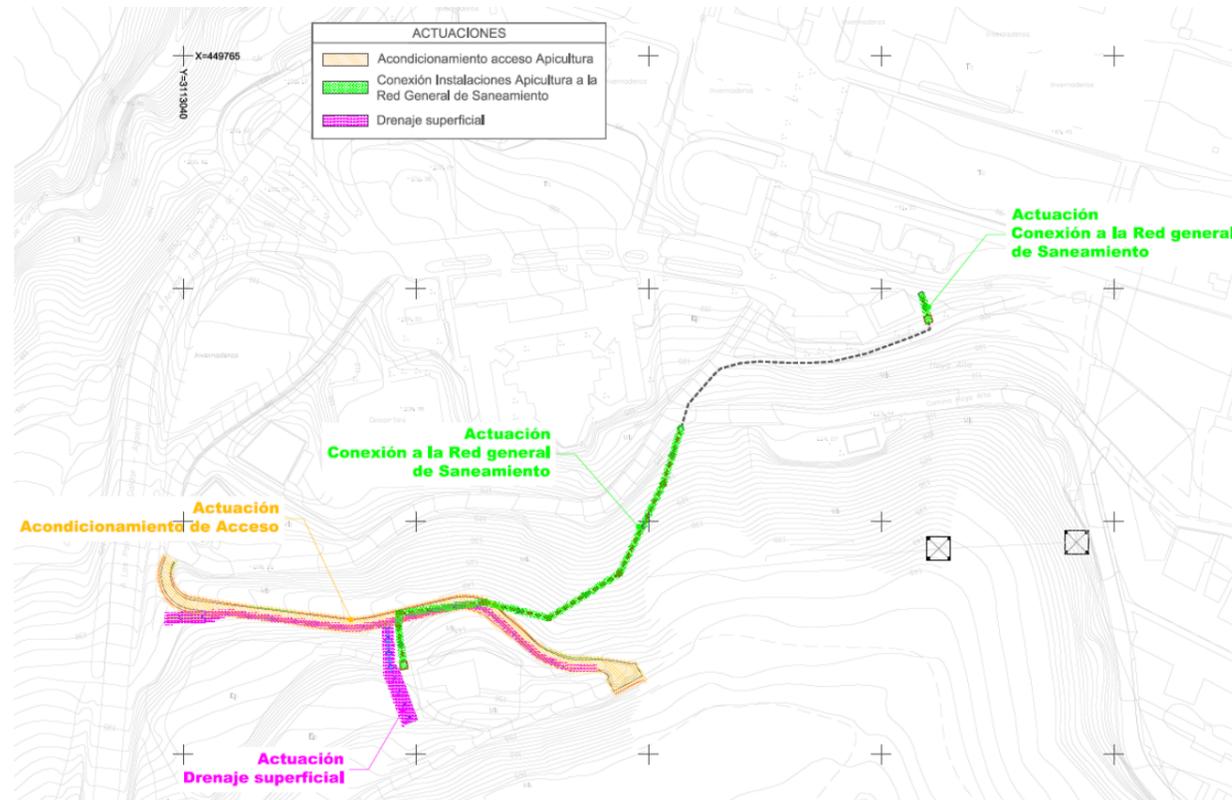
Plano 2.3. PLANTA GENERAL DE ACTUACIONES
